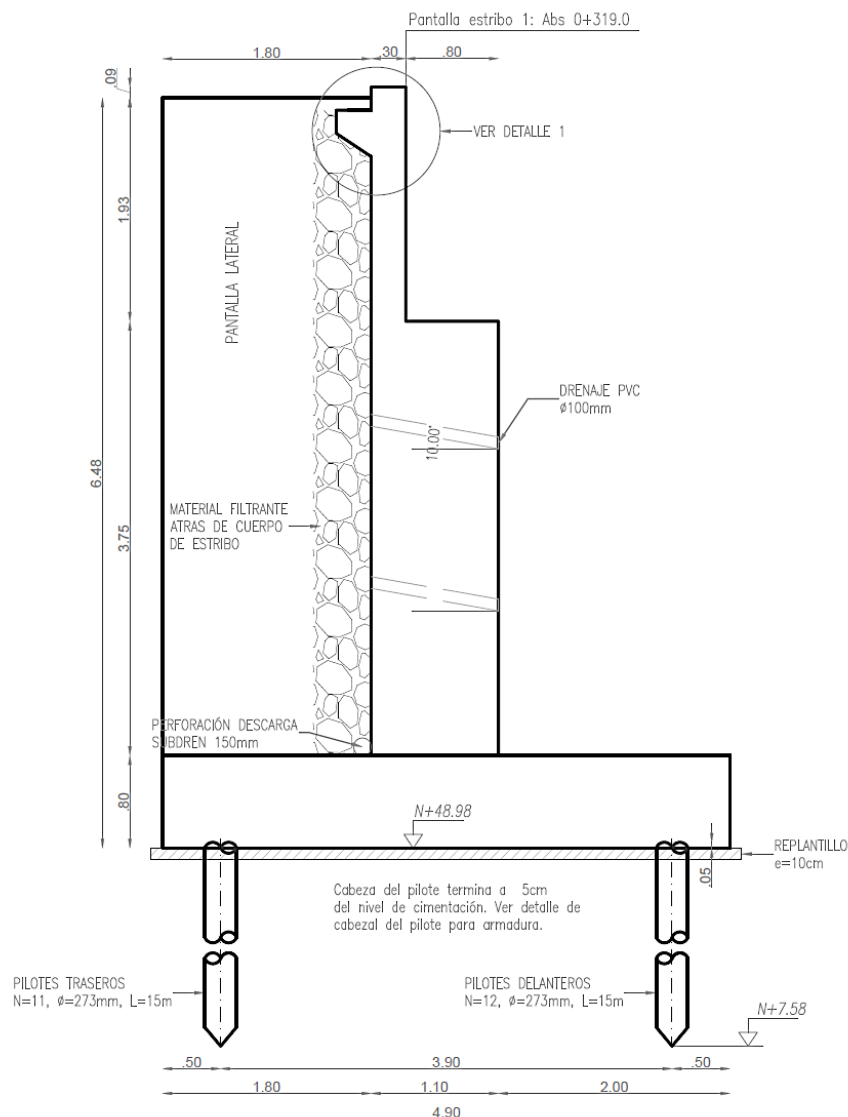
Estribo Izquierdo Río Zapatillo.
